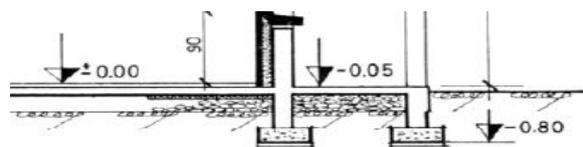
Plan de coupe de fondation avec altimétrie en NGF
